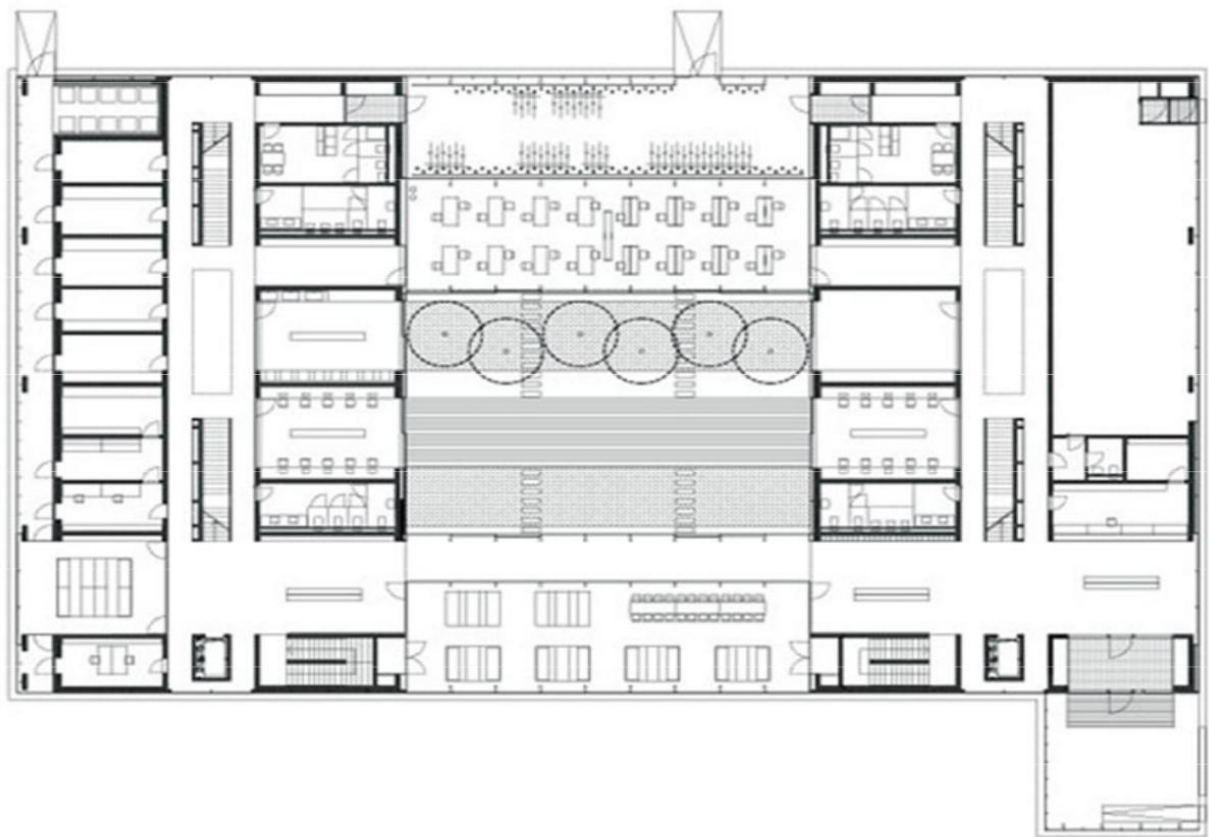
Planta do pavimento térreo da Residência Universitária Poljane
